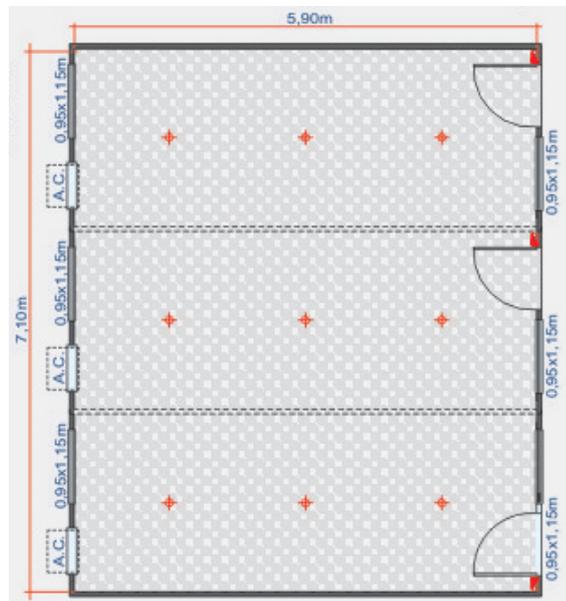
Planta de módulos conjugados de contêineres. Fonte: Afa Locações (AFA, 2014).
